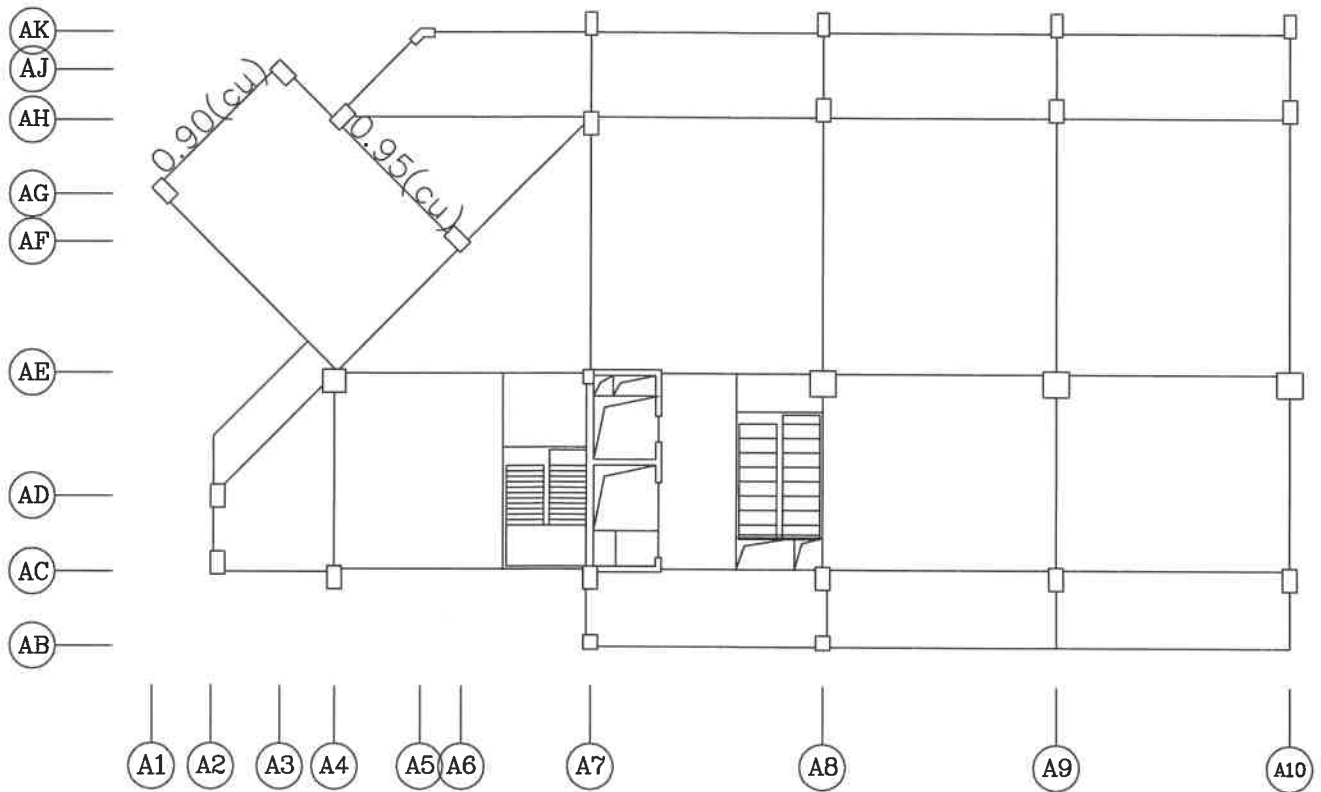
2 层混凝土梁承载力不足的构件示意图（代表层 1）
